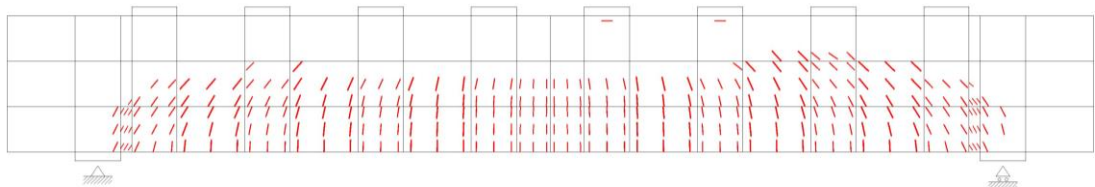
破壊時の変形及びひび割れ状態 (Case No. 10)
